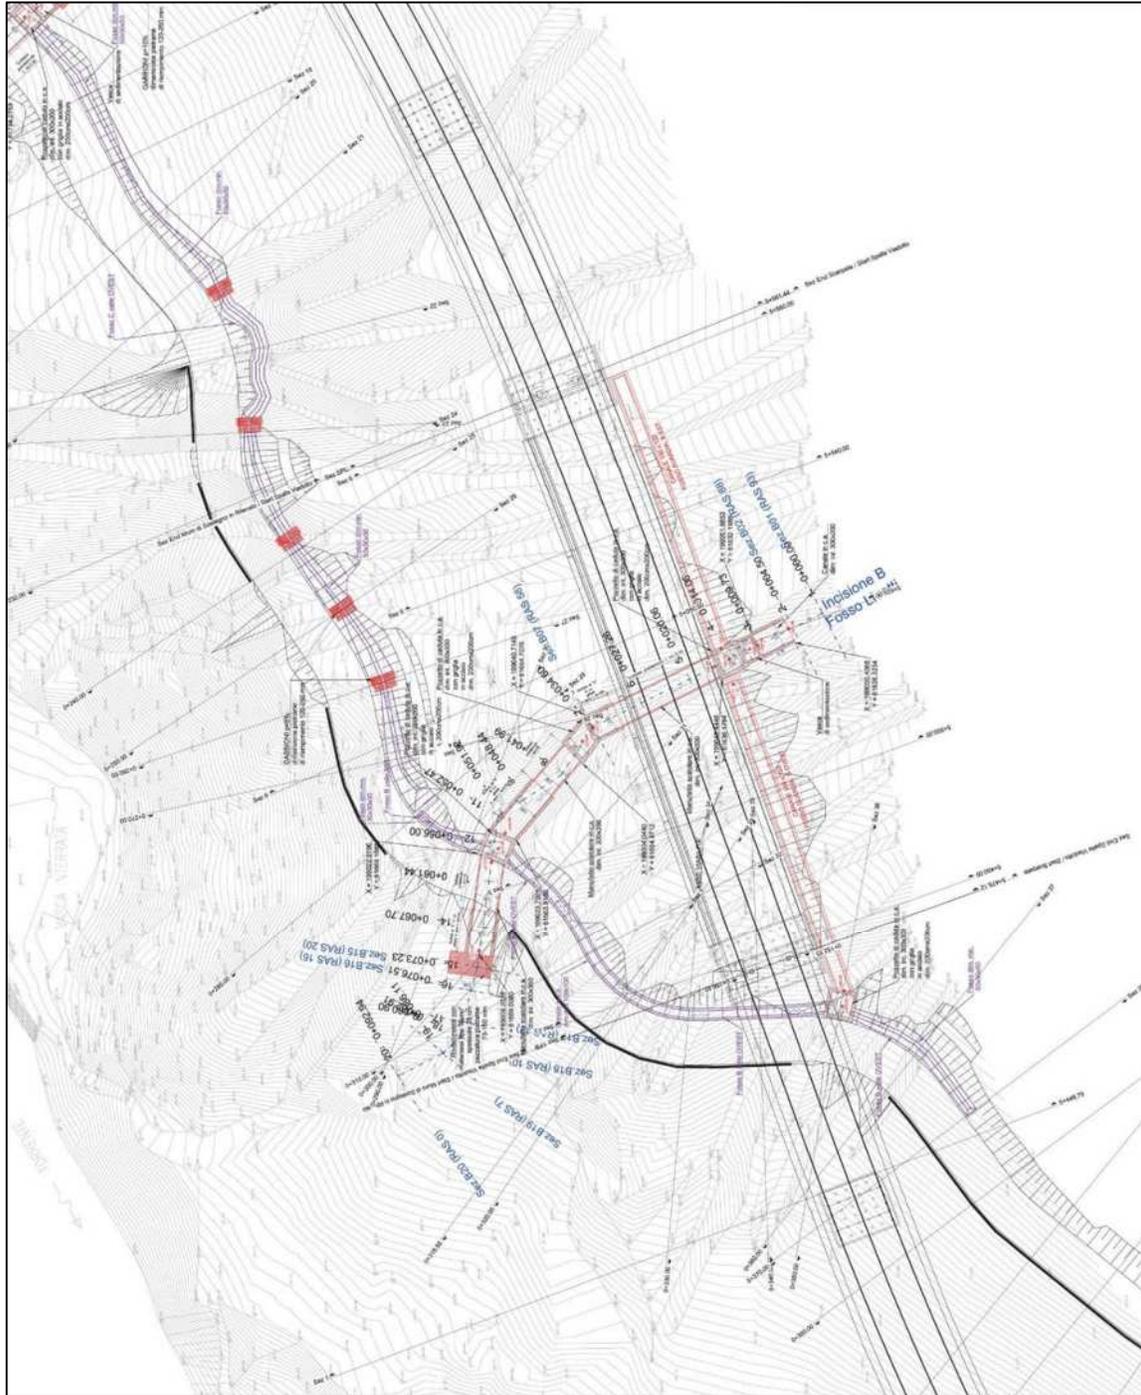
Incisione B e fossi di guardia afferenti – Planimetria di progetto
